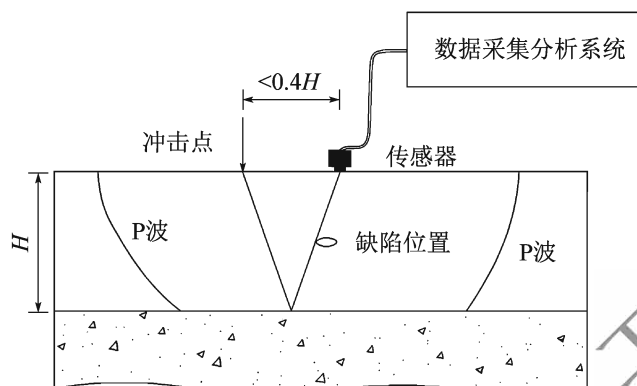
冲击回波测试混凝土厚度和缺陷示意图
